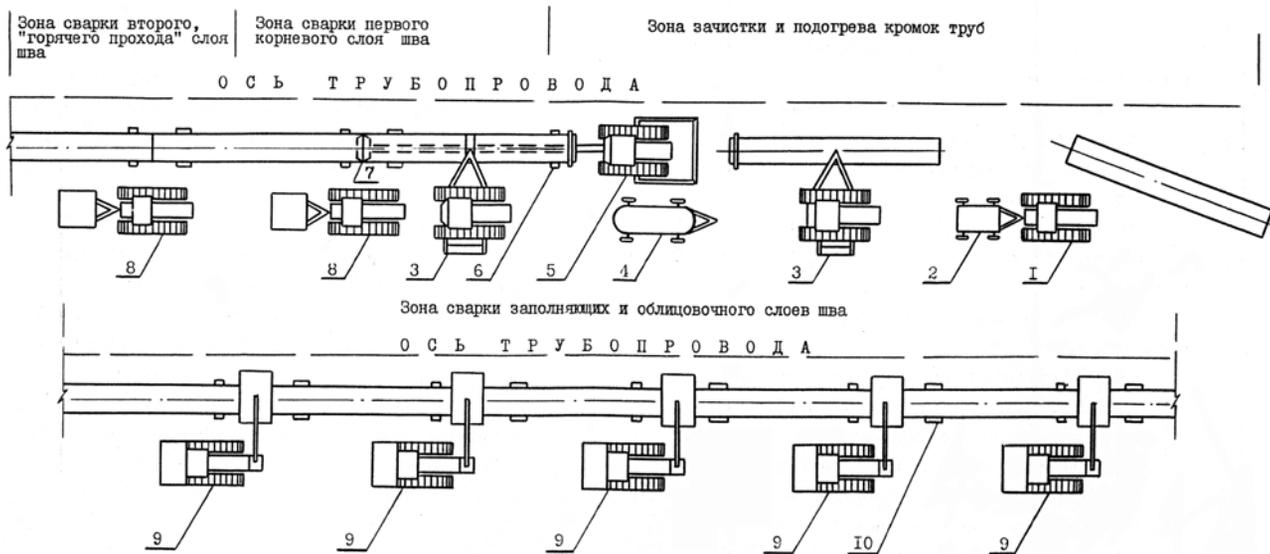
Схема сборки и сварки трехтрубных секций в нитку:
